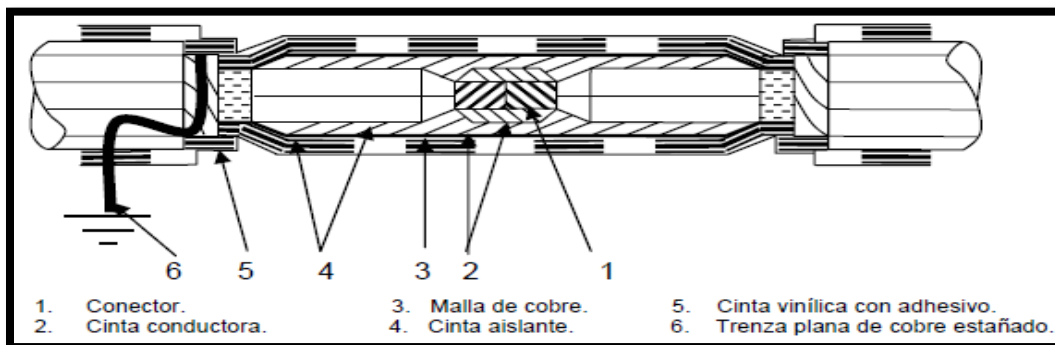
Detalles constructivos de empalmes encintados en cable monofásico con aislamiento extruido [21].
